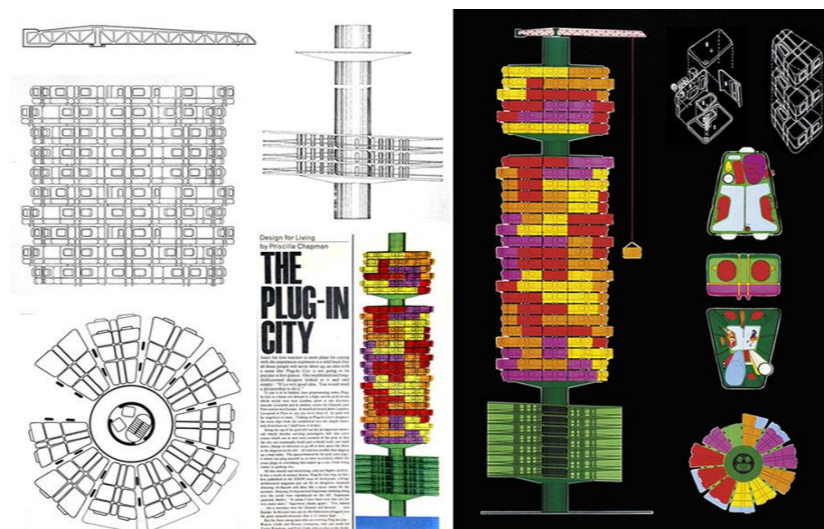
capsuça Homes. Tower and capsule elevations, plans and details. Fonte: <https://archigram.net/portfolio.html>
